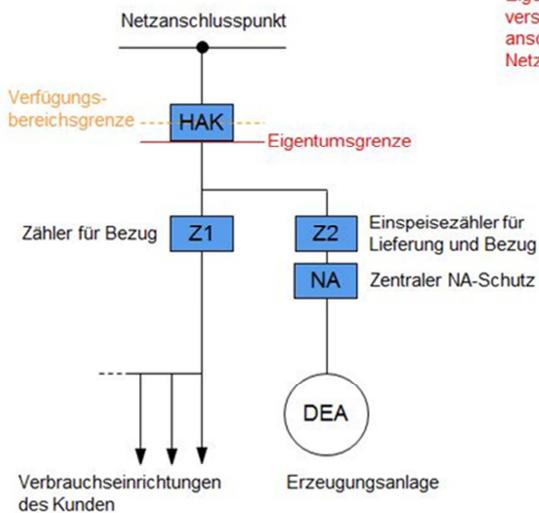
und A4: Anschluss bei Anlagenleistungen > 30 kW je Grundstück
